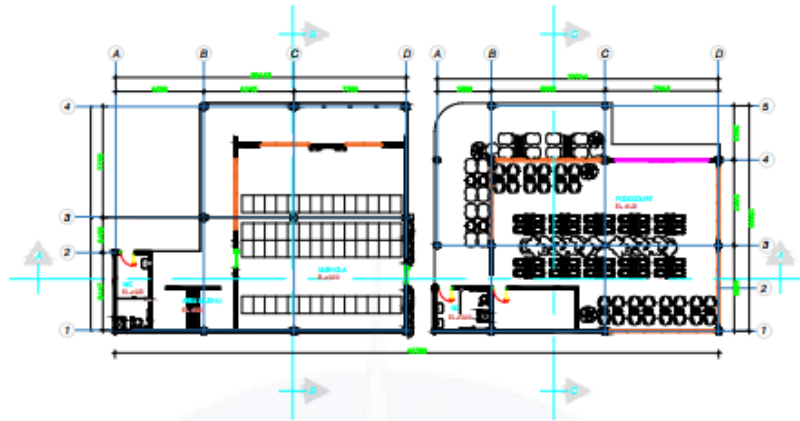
6 Denah Gedung Siswa Lantai 1
